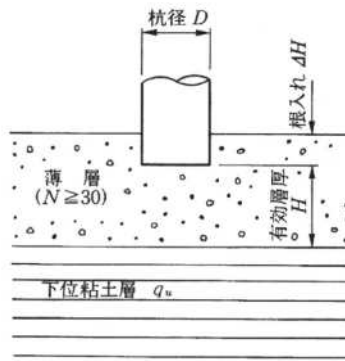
薄層支持の概略図 (便覧図-参 5.1)
